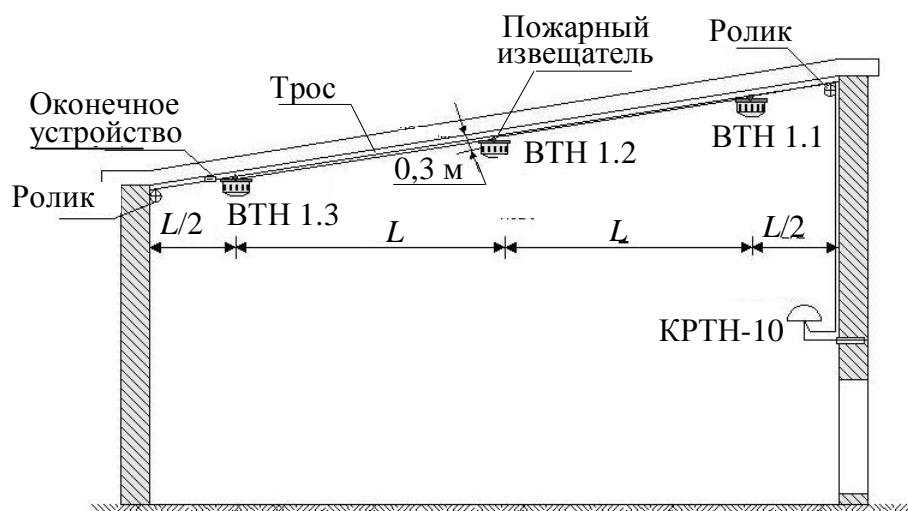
Вариант схемы размещения АПИ на тросах под перекрытием здания
